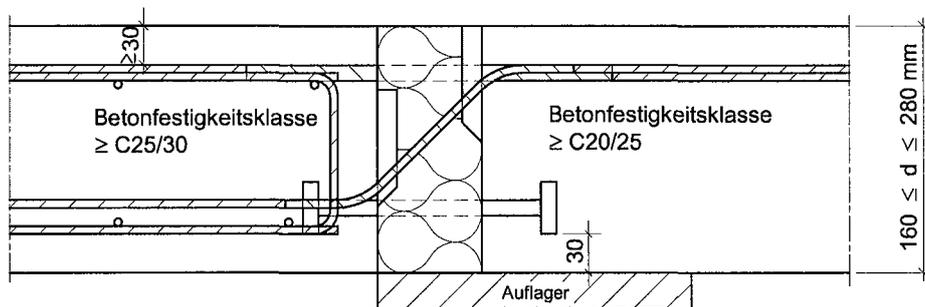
Beispiel Schöck Isokorb Typ K mit Aufhängebewehrung nach Abschn. 3.2.1
